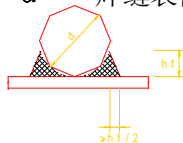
1 圆钢与平板间的焊缝
